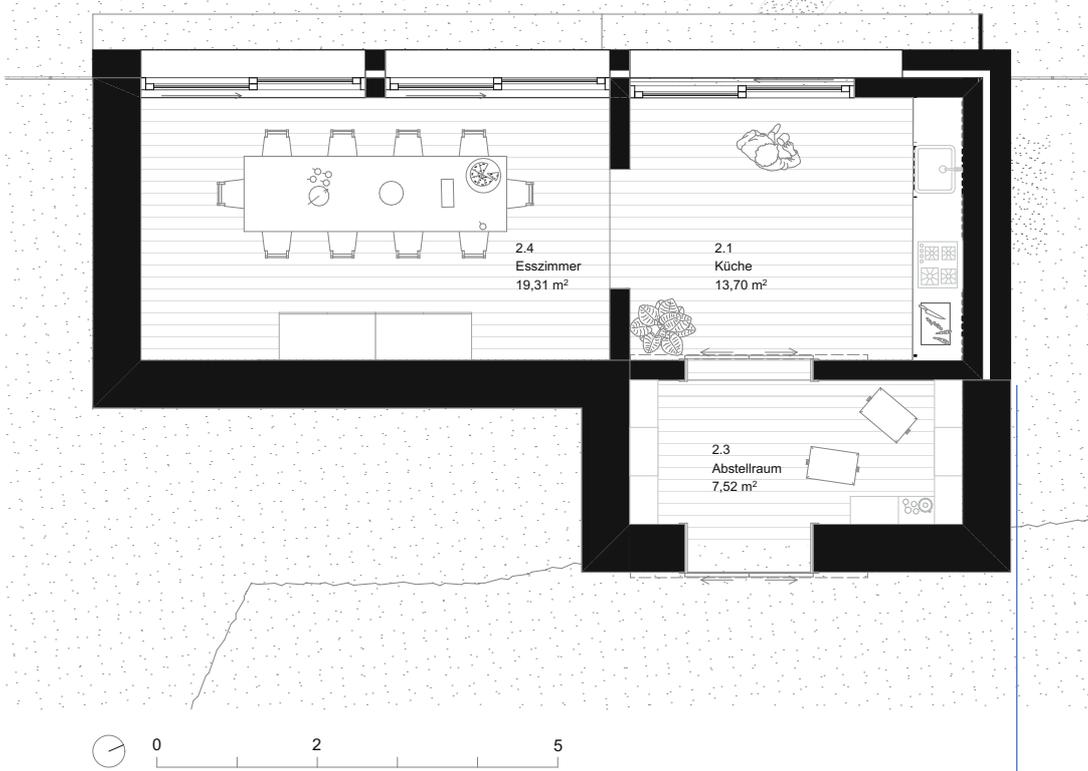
Küche, Grundriss Neugestaltung
